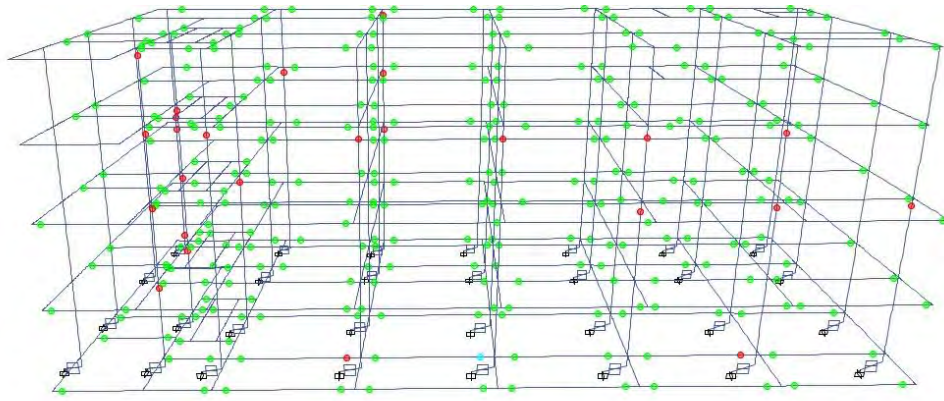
MECANISMO DE COLAPSO EN LA DIRECCIÓN LONGITUDINAL
